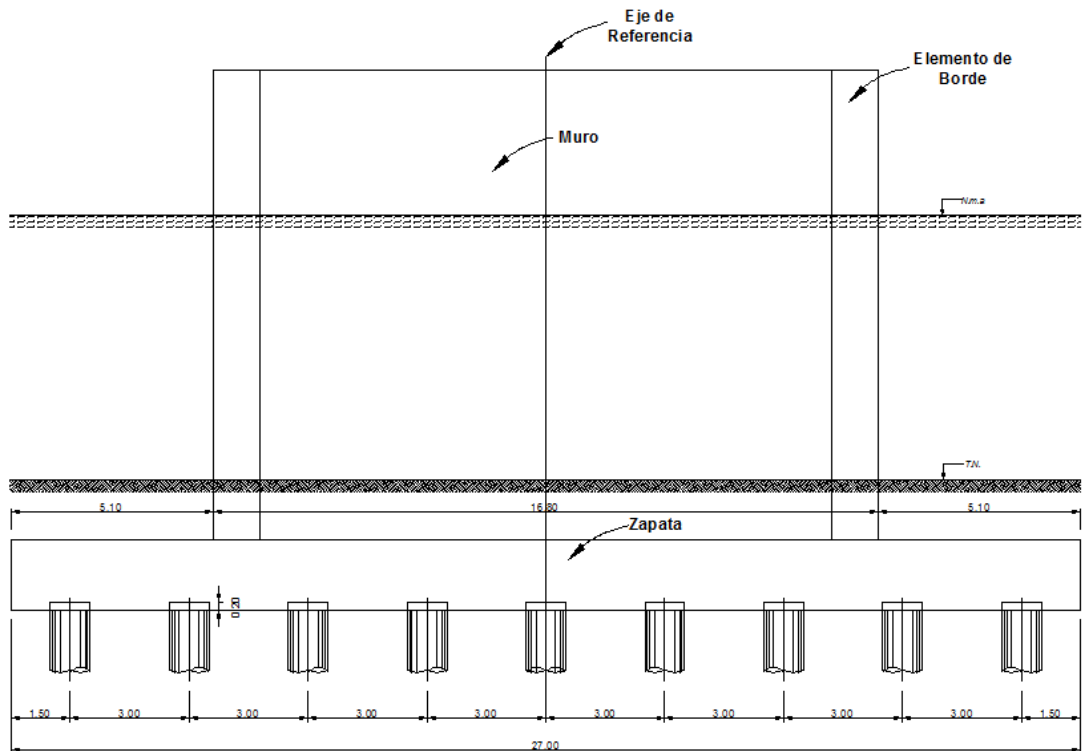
Distribución frontal de pilotes para la pila P3.
